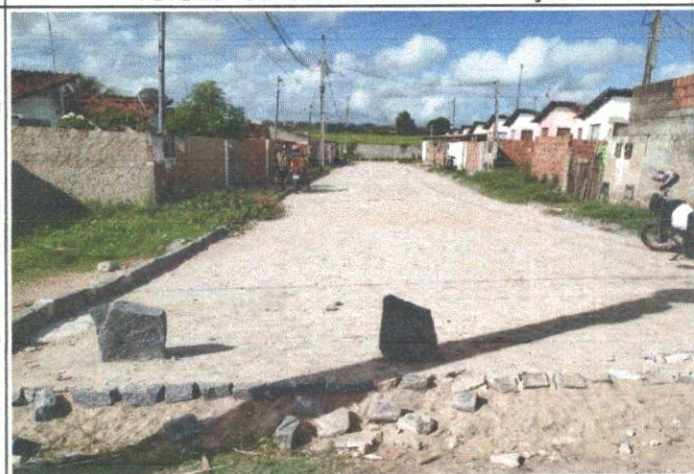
CONCLUSÃO DA PAVIMENTAÇÃO
